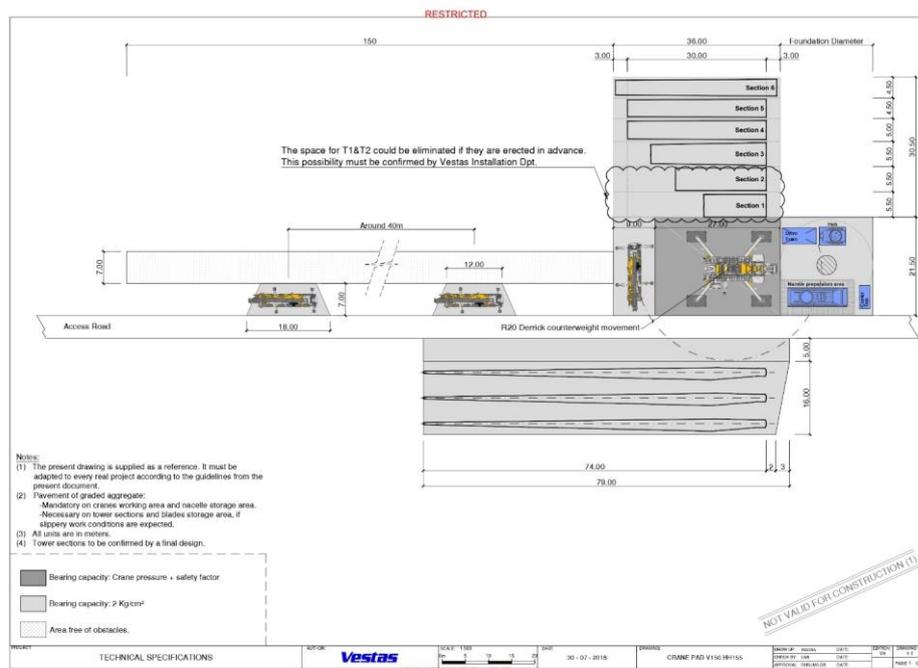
Piazzola di montaggio tipo previsto dalla Vestas
